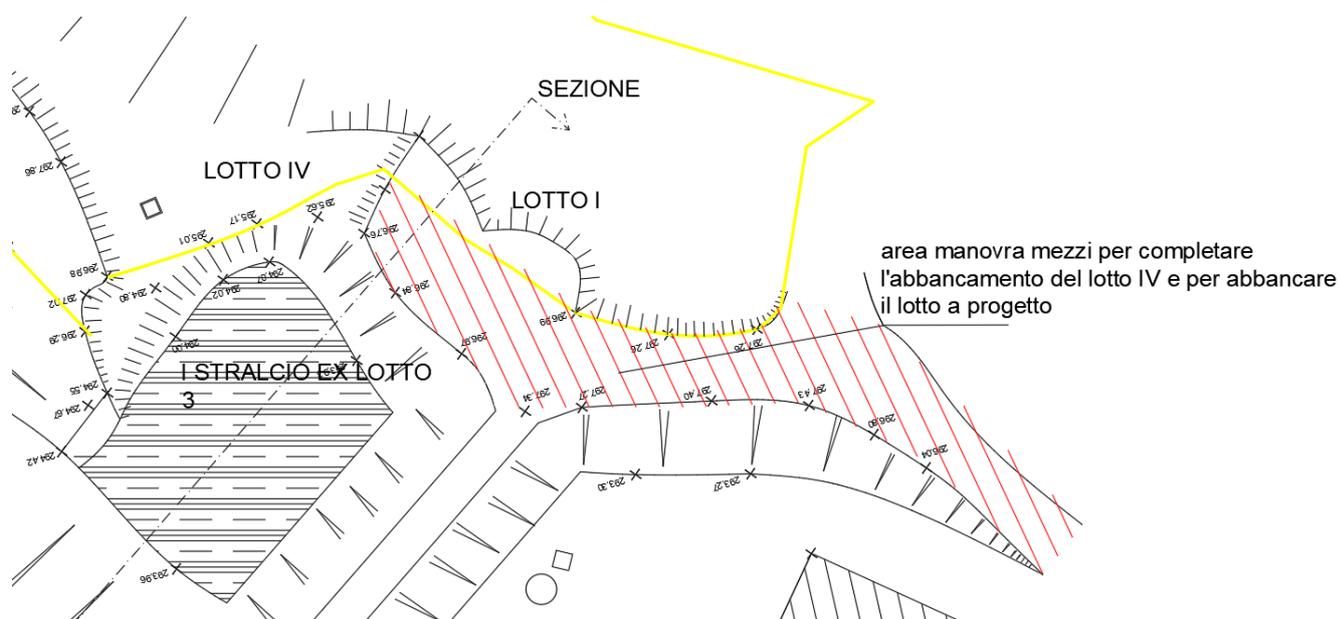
stralcio planimetrico dell'area a confine del lotto a progetto con il lotto IV e il lotto I
